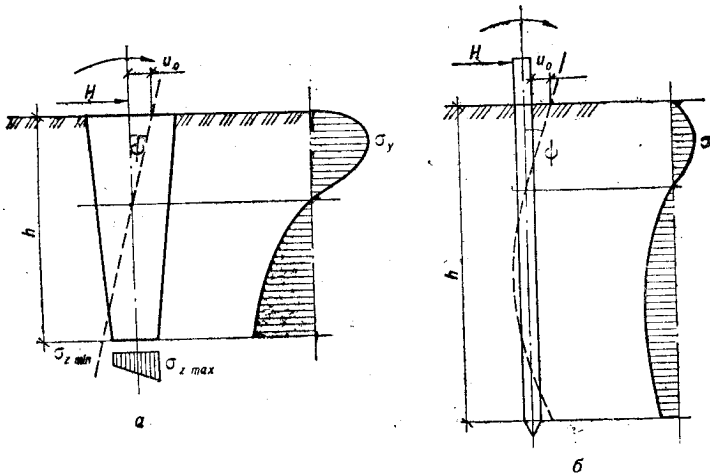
Схеми роботи фундаментів, споруджуваних без виїмання ґрунту, на дію горизонтального навантаження: а — абсолютно жорсткі; б — кінцевої жорсткості
